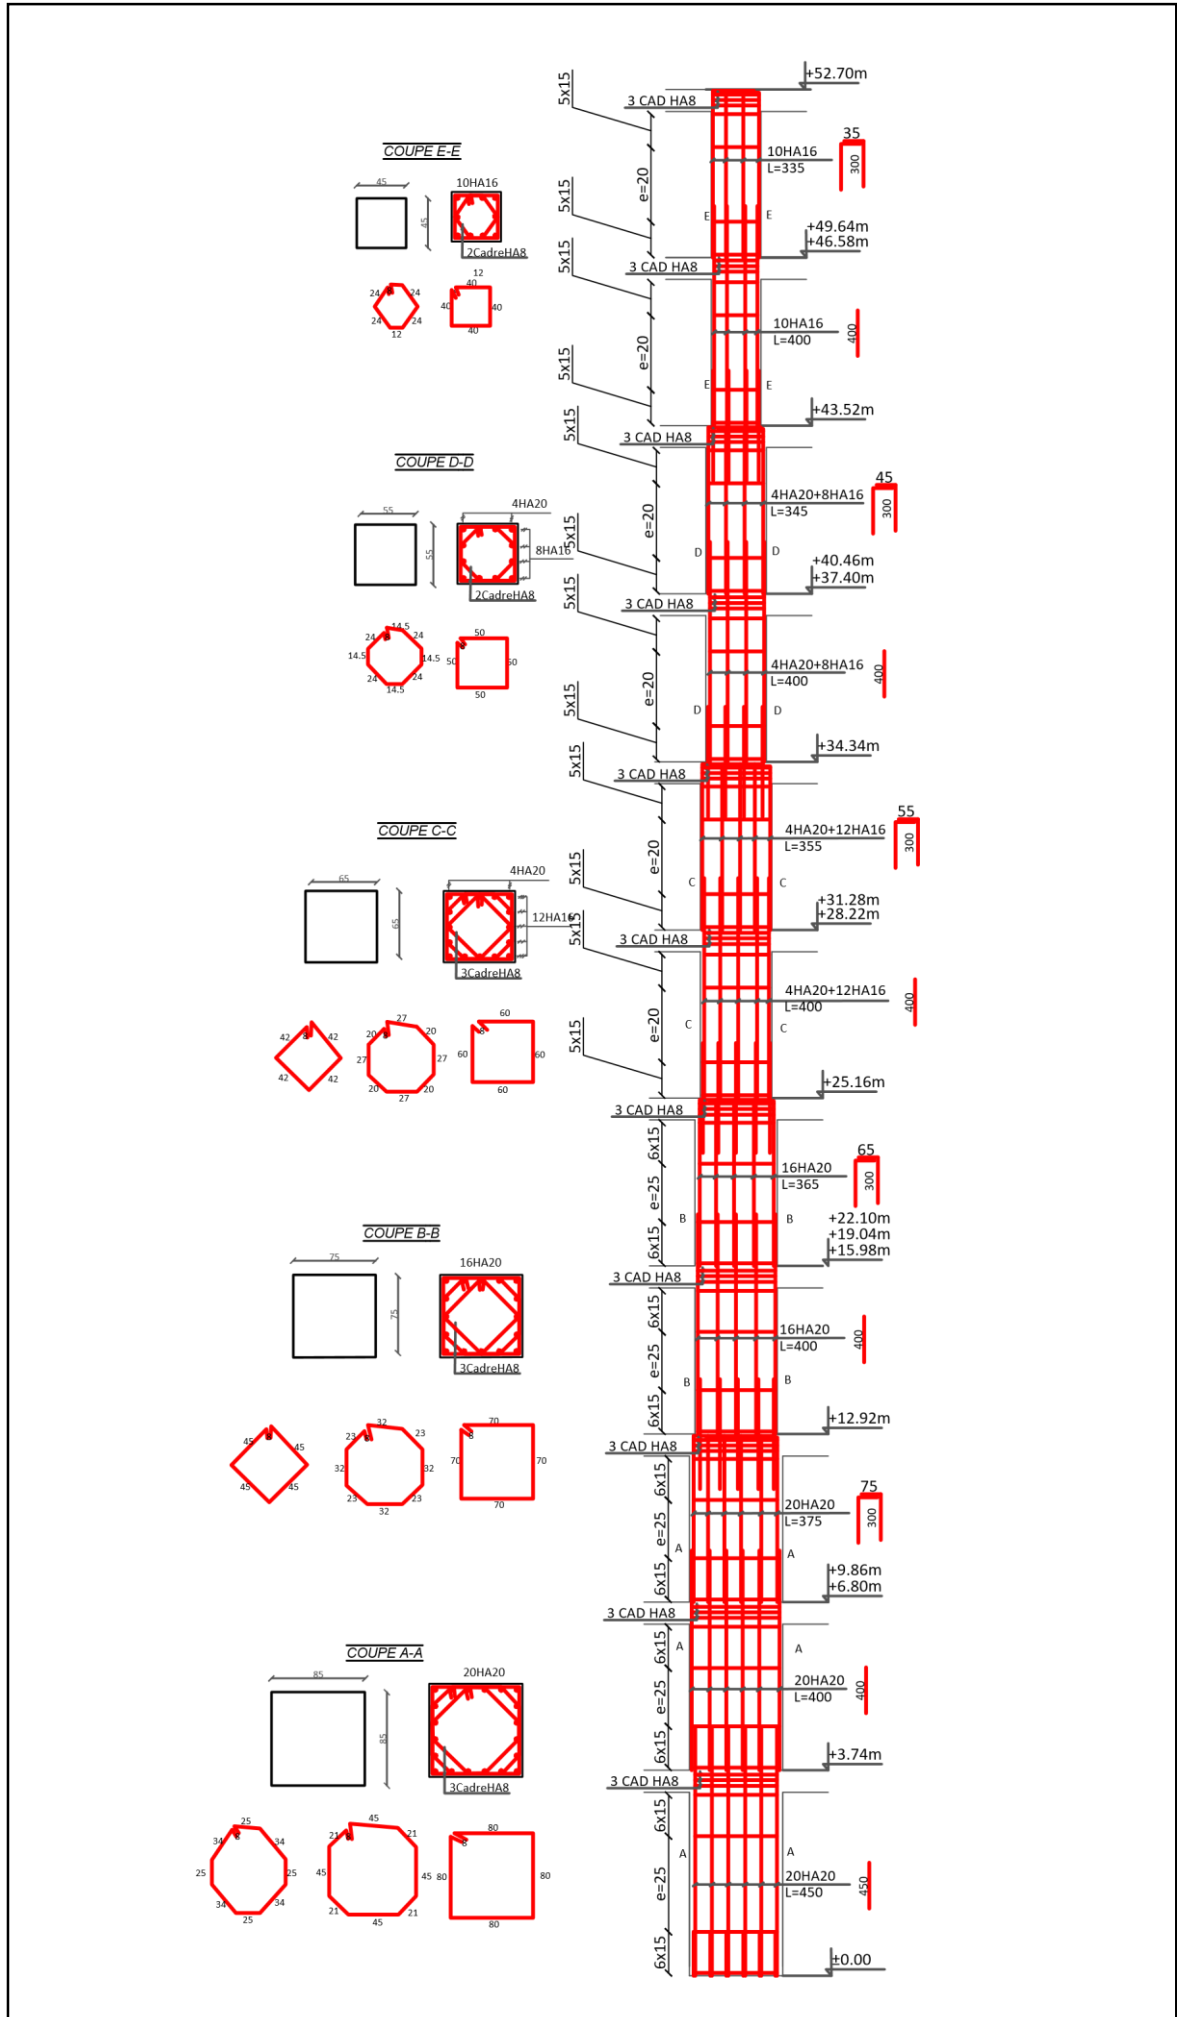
Ferrailage poteau intermédiaire "P2".
